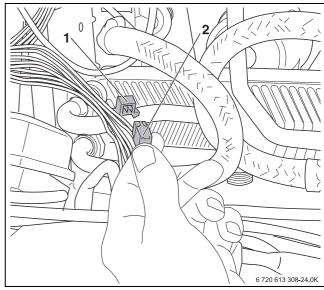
Stecker für Warmwasser-Temperaturfühler aufstecken
